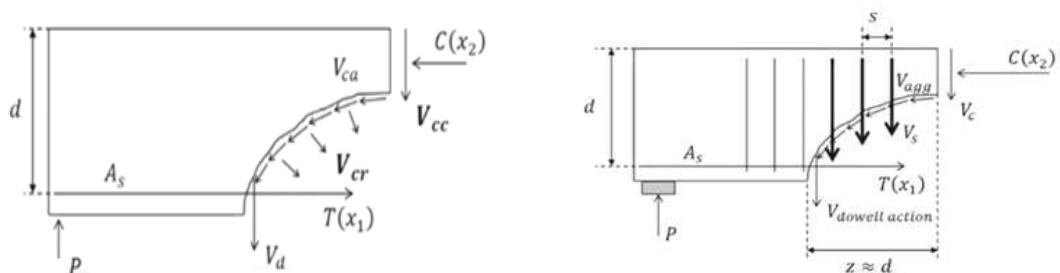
Cisaillement dans un élément poutre en B.A (ou voile-structurel) avec et sans armature transversale [8].
